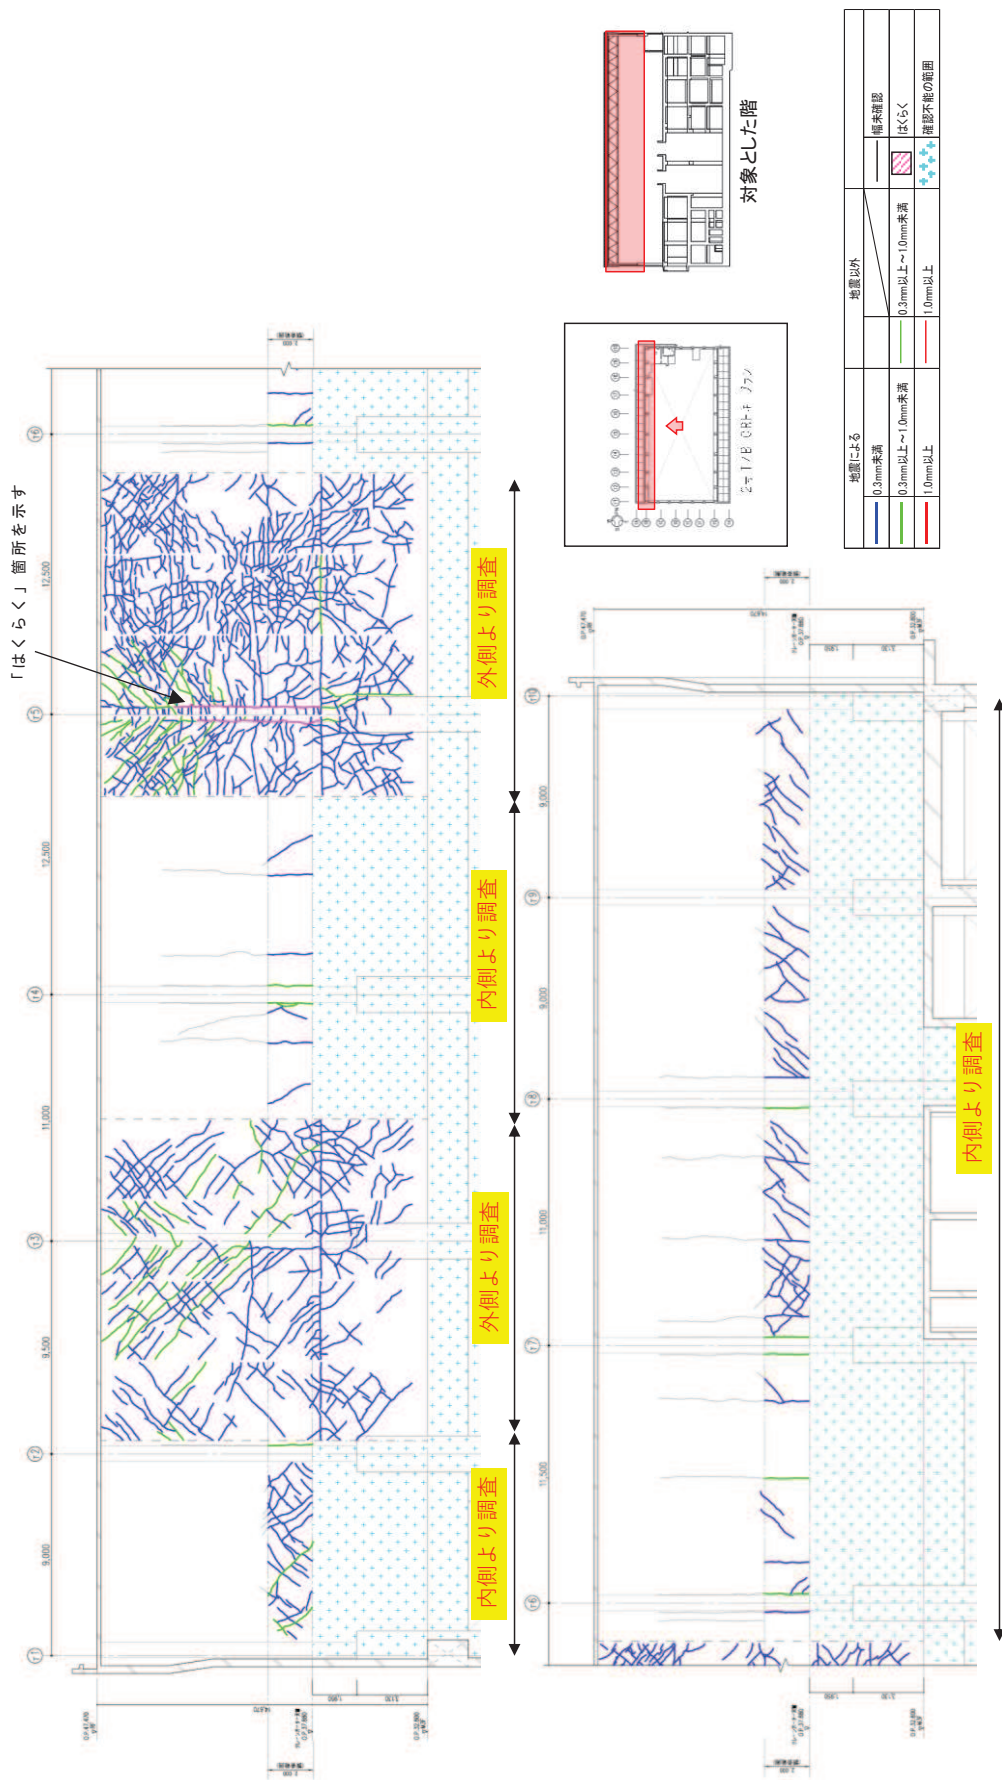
タービン建屋のひび割れ分布 耐震壁 (53) クレーン階 TB 通り
